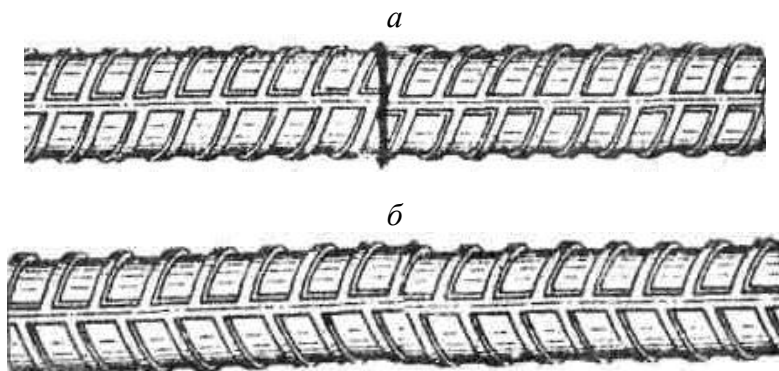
Образцы для оценки контактно-стыкового сварного соединения:
